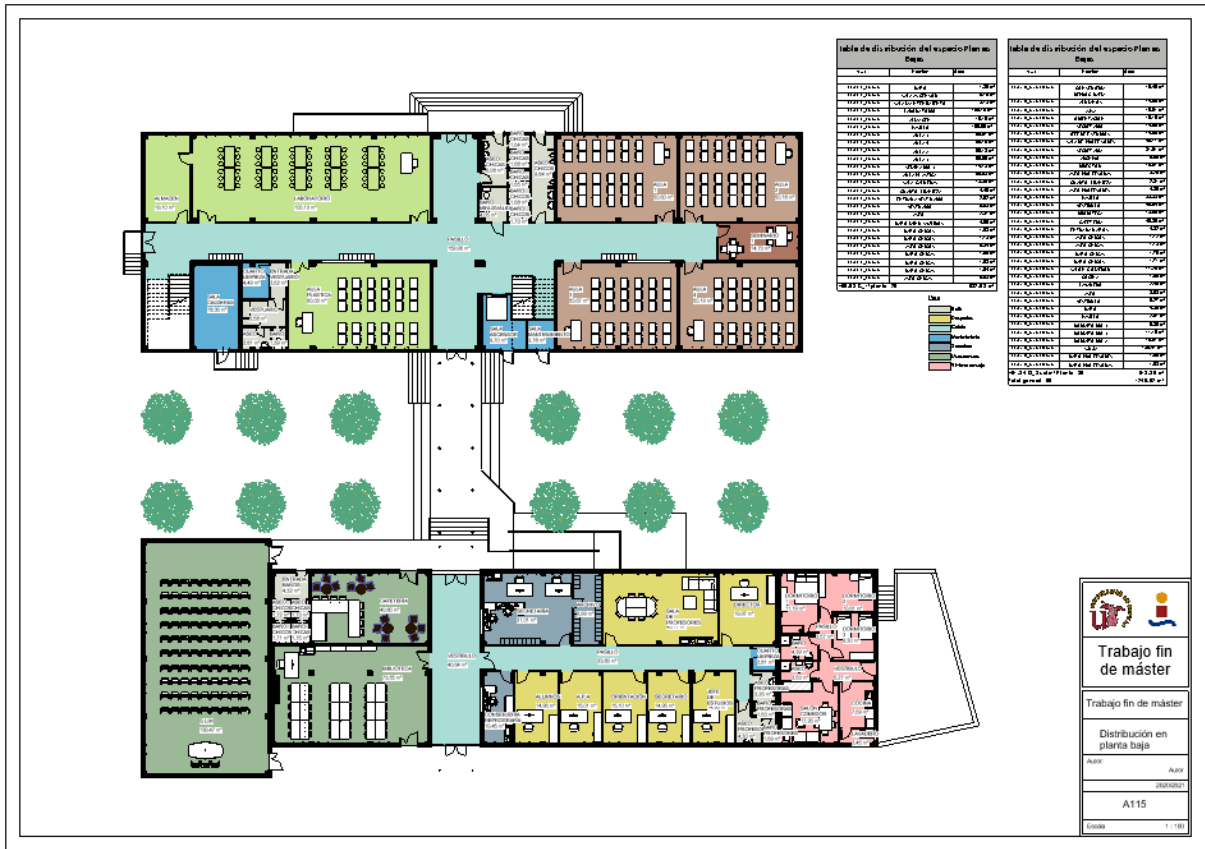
Plano A1 de distribución en planta baja con tabla de contenido
